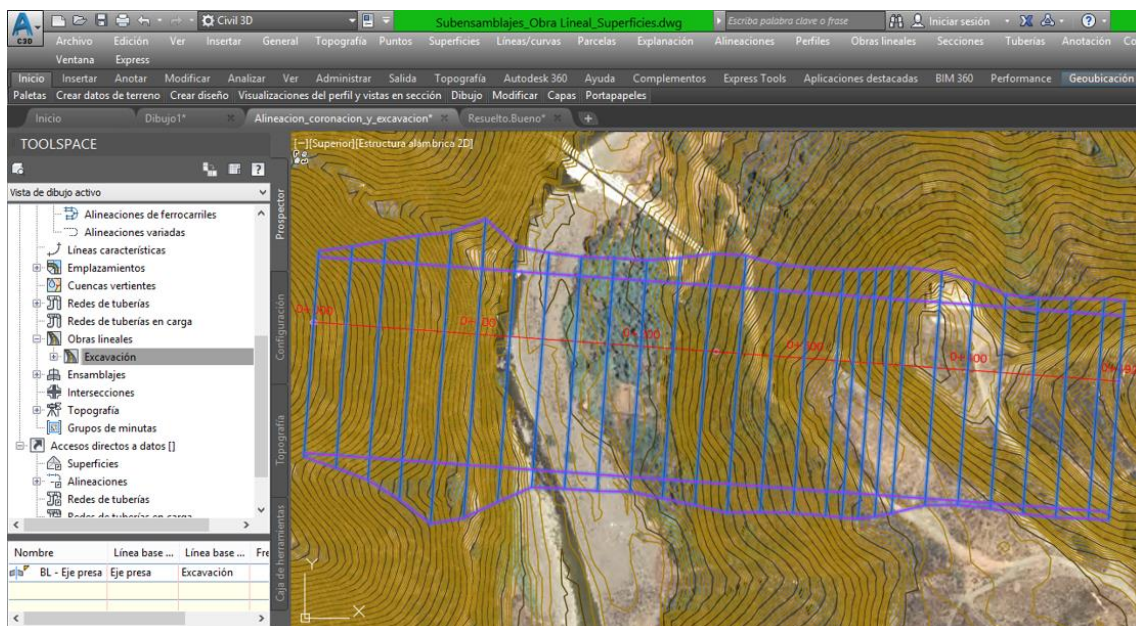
Excavación. Obra Lineal: Excavación (2)
